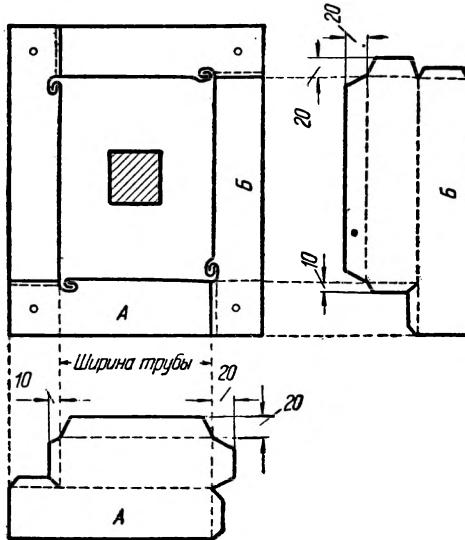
Покрытие верха дымовых и вентиляционных труб (второй способ)
